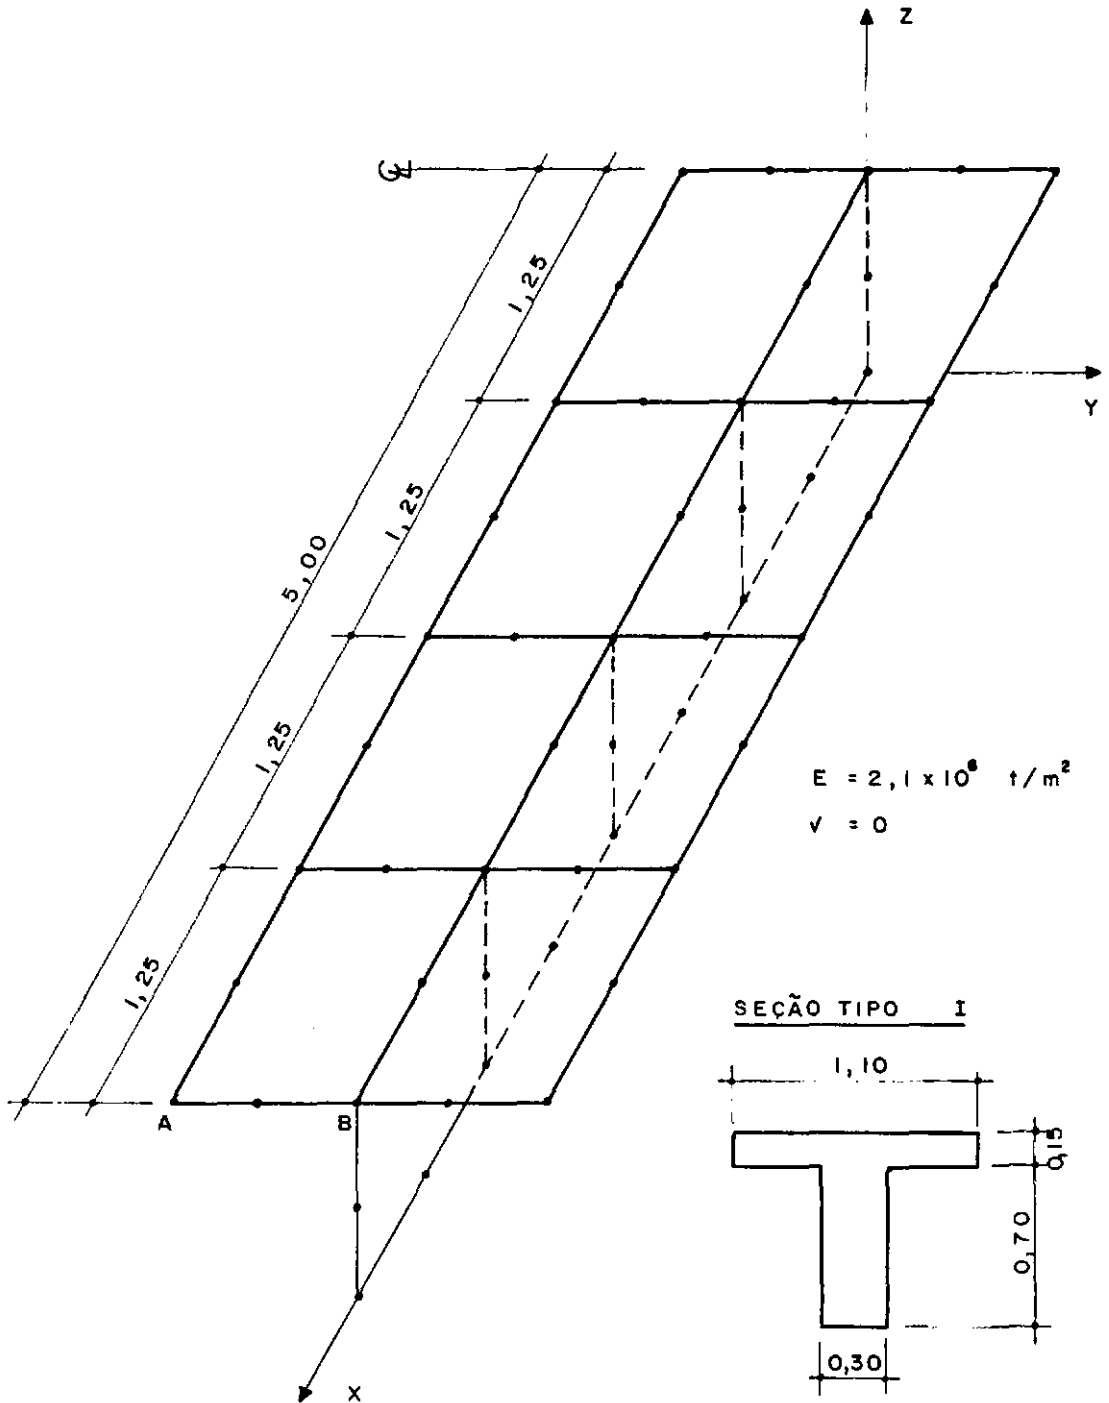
a - VIGA COM SEÇÃO T - ELEMENTO "PRILDO"
